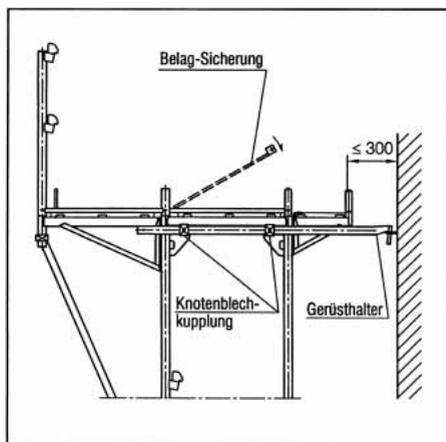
Gerüsthalter (Euro-Stellrahmen)
